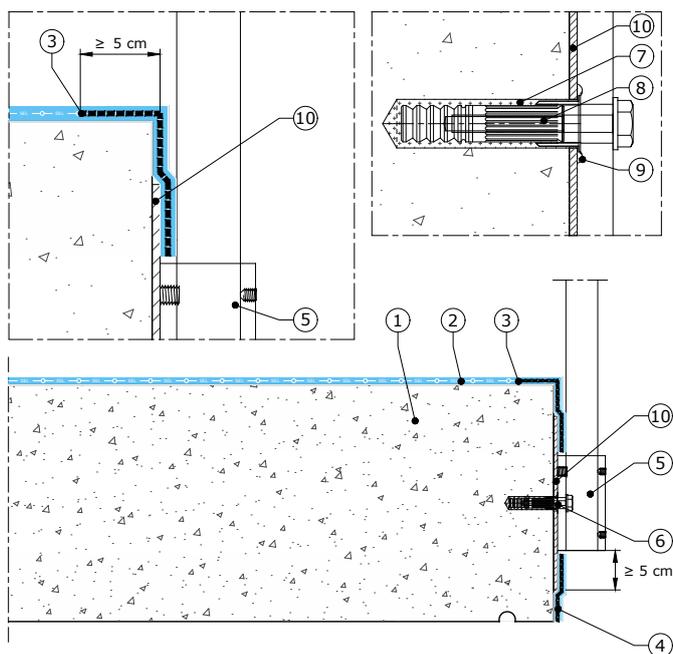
Garde-corps avec fixation en applique - Nez de dalle étanché - Exemple
